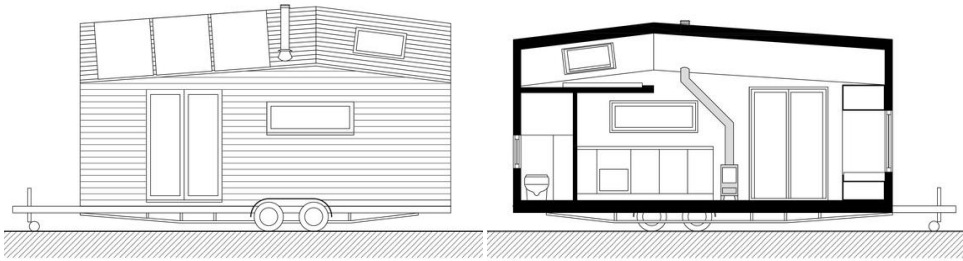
Bemmell Planı (Contemporary Tiny House / Walden Studio | ArchDaily).
